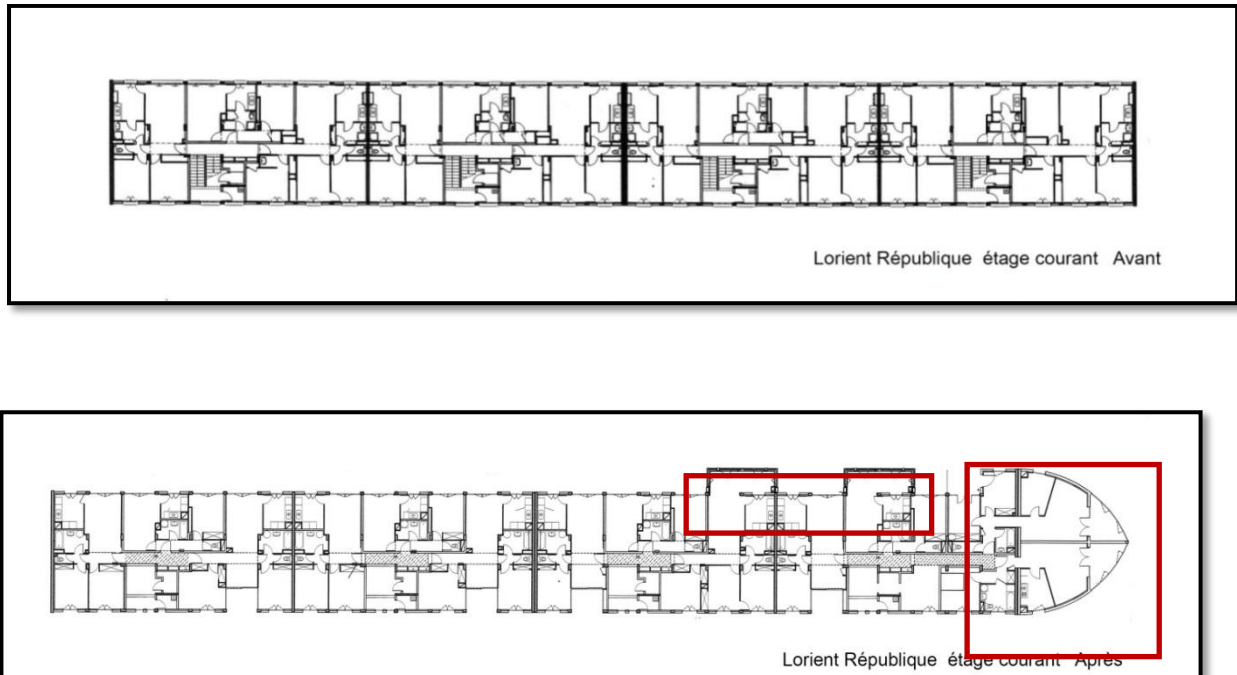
les plans d'un étage de la barre avant et après le modelage.
